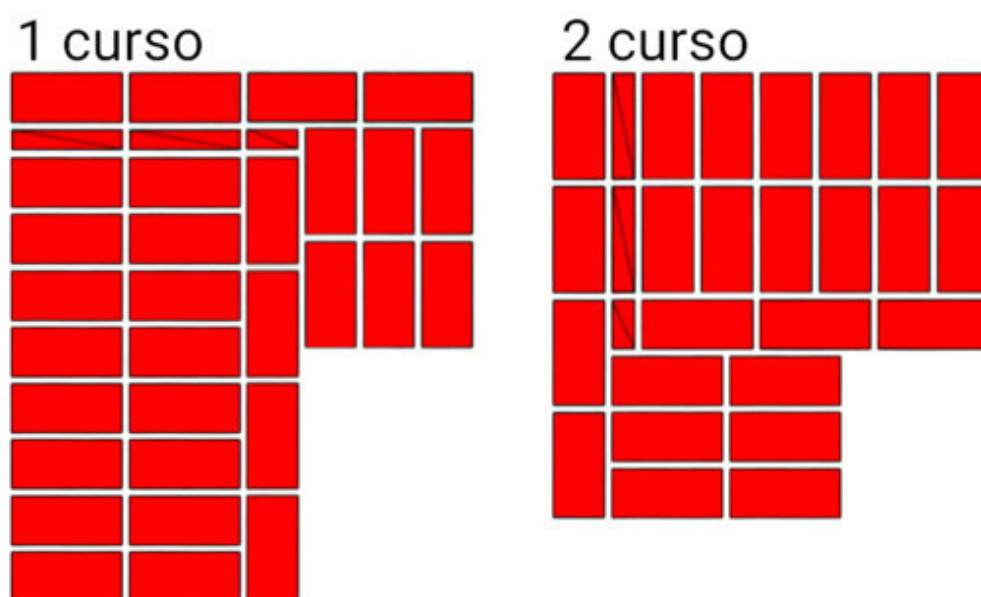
A ordem de colocar tijolos no canto das paredes. Espessura da parede 2,5 tijolos.
